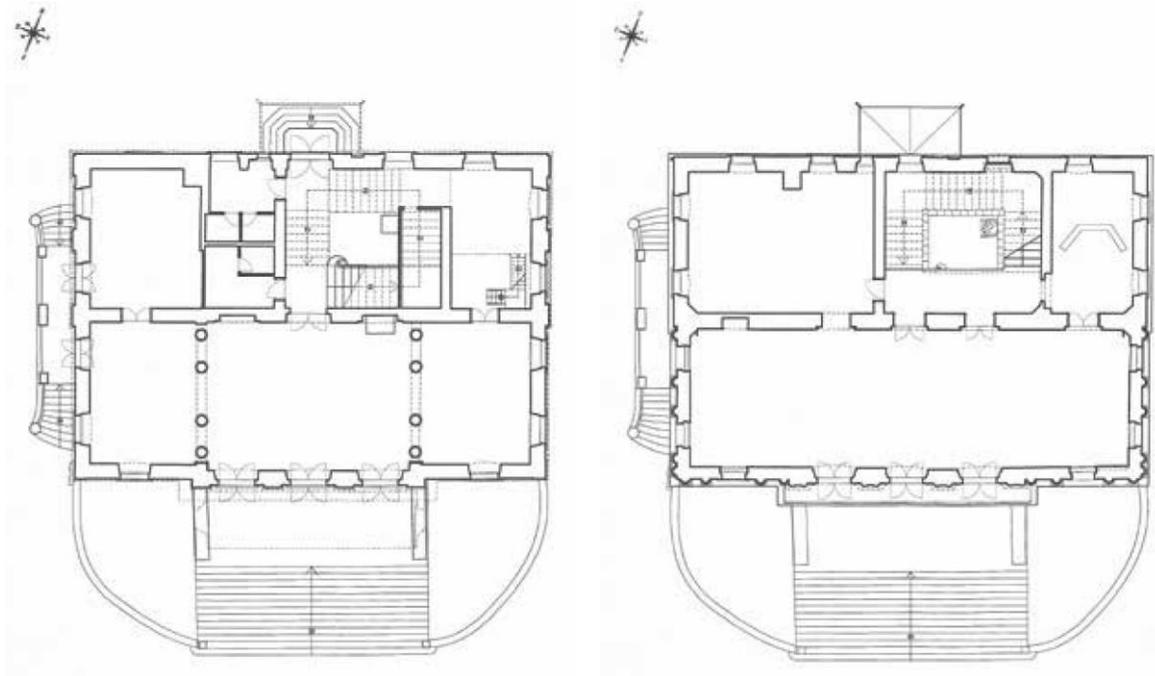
Grundrisse der Villa Angiolina, Erdgeschoss und Obergeschoss, 1844
